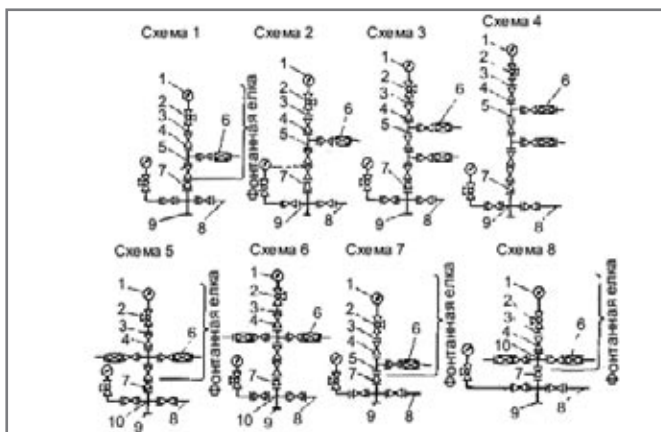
Типовые схемы фонтанных арматур: 1 – манометр; 2 – вентиль; 3 – буферный фланец под манометр; 4 – запорное устройство; 5 – тройник; 6 – дроссель; 7 – переводник трубной головки; 8 – ответный фланец; 9 – трубная головка; 10 – крестовина елки.
